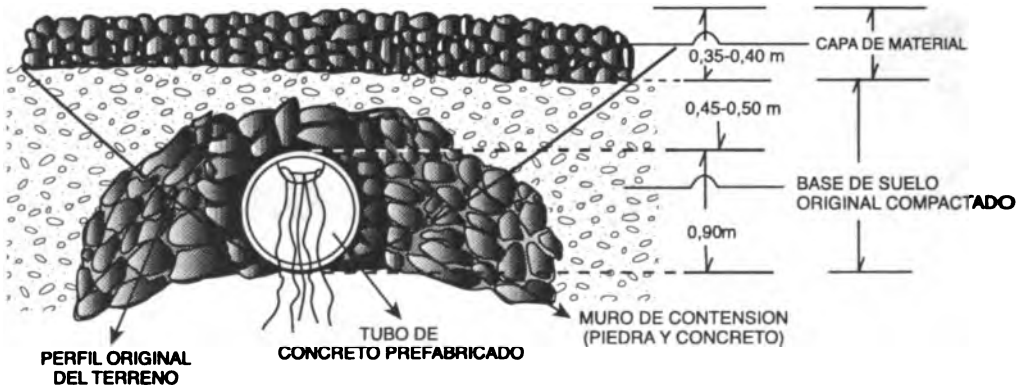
Corte transversal de una alcantarilla para una quebrada.
